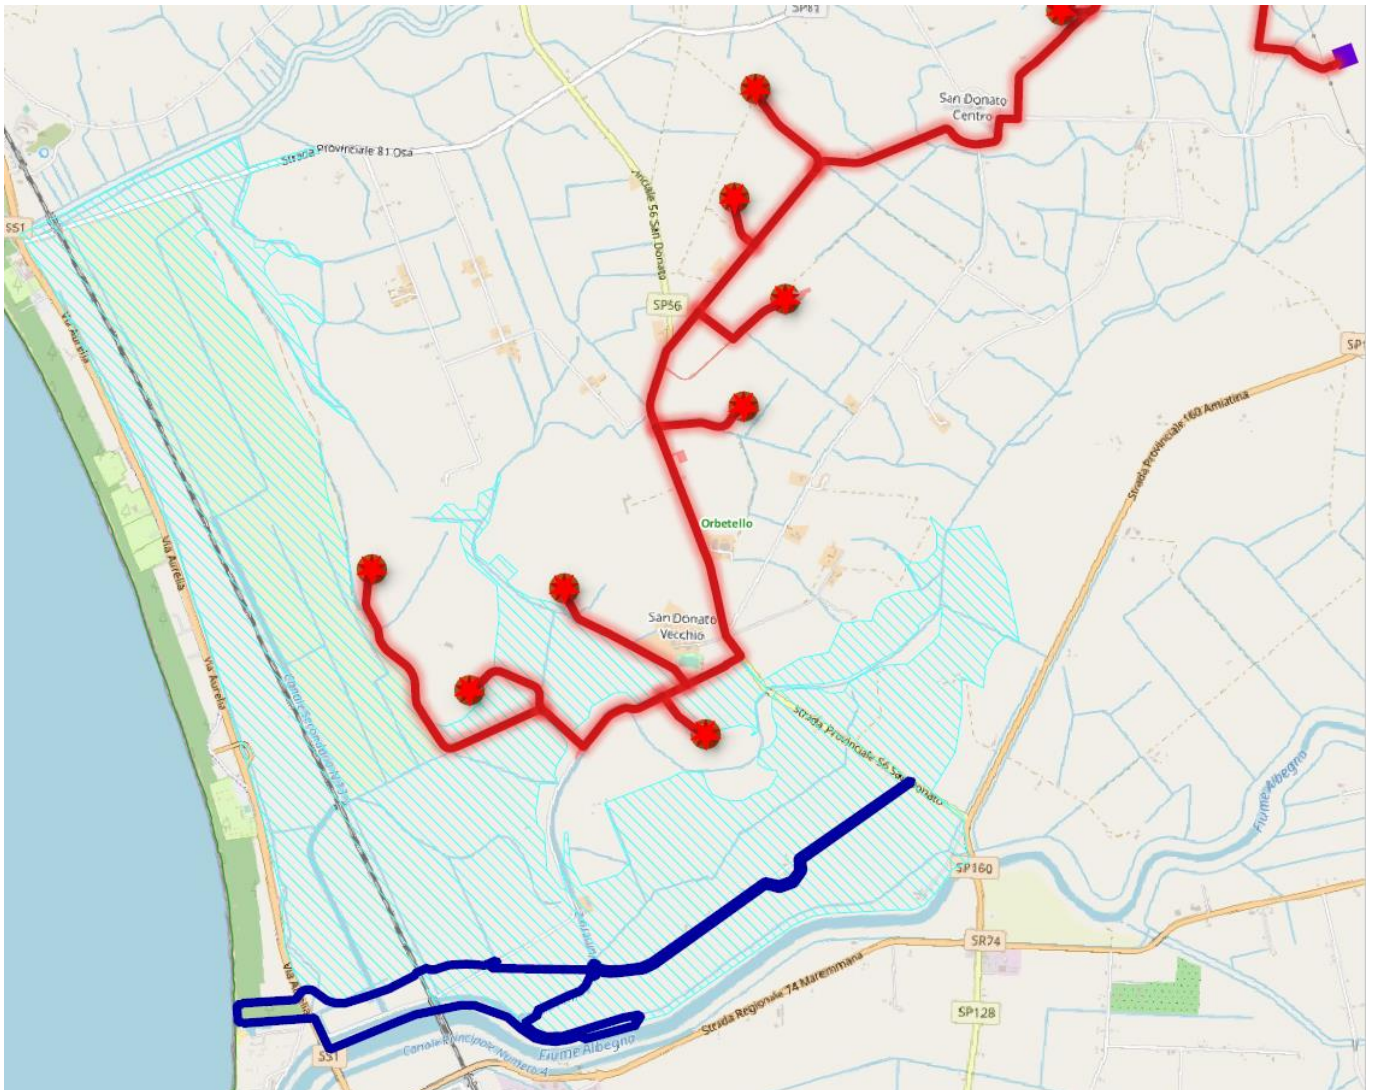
Raffronto tra la planimetria di progetto dell'impianto eolico e la cassa di espansione
